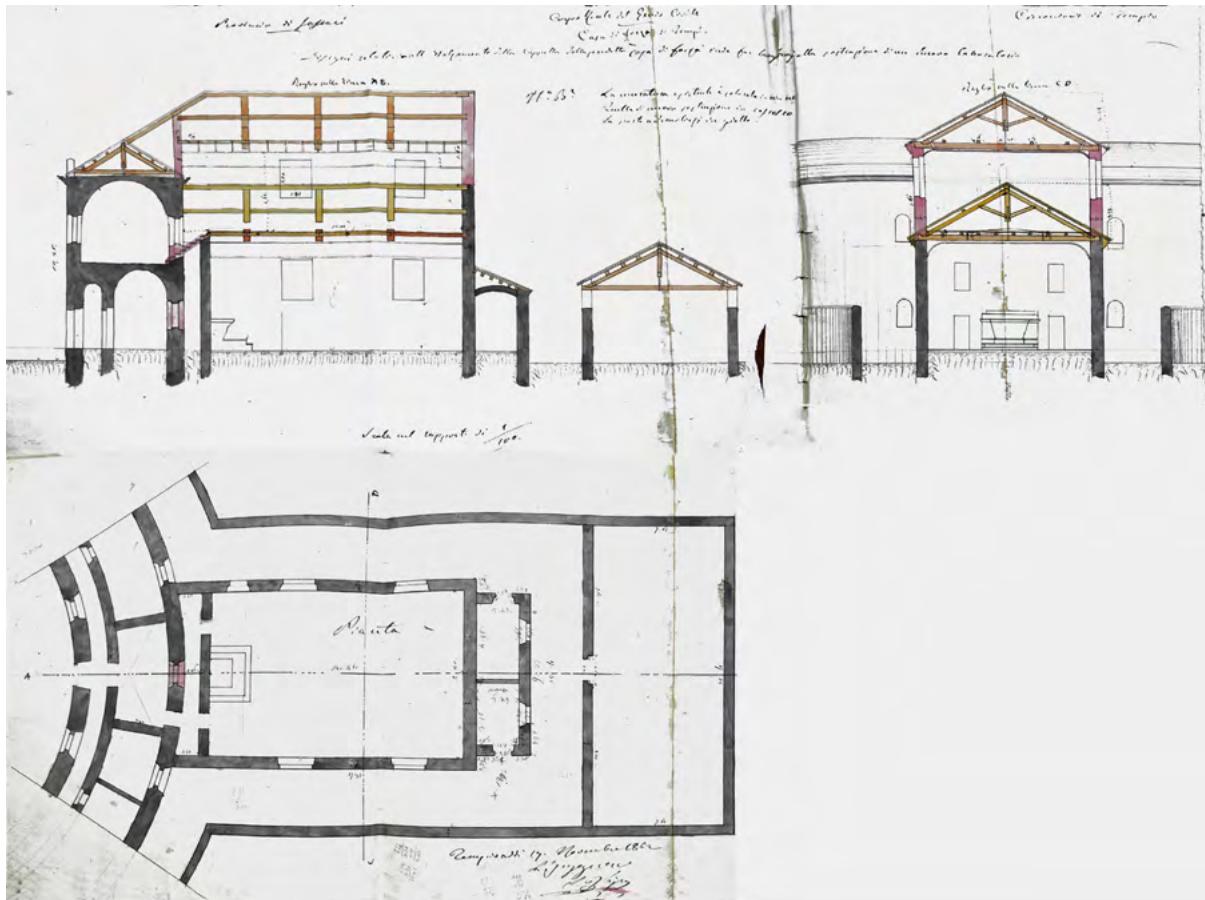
Carcere di Tempio Pausania, pianta, sezione longitudinale e sezione trasversale, 1862, penna, inchiostro nero e acquerello. AGCSS Cart. 1/116, fasc. 1/A, sotto fasc. 2, 17 novembre 1862, cc. s. n.
